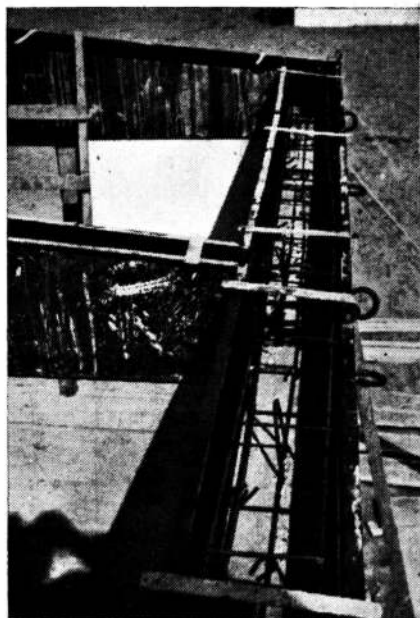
Molde metálico para encadenado; armadura y cañería eléctrica.
